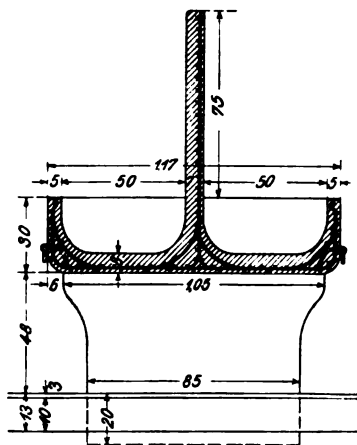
Doppelter Futterbarren mit tragendem Boden.
